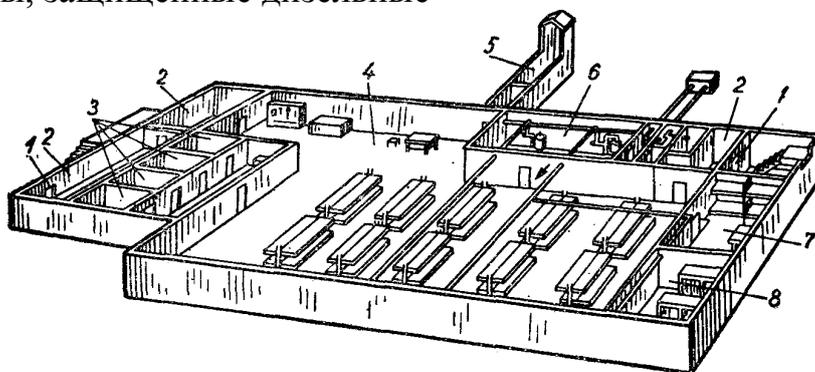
План убежища: 1—защитно-герметические двери; 2—шлюзовые камеры (тамбуры); 3—санитарно-бытовые отсеки; 4—основное
